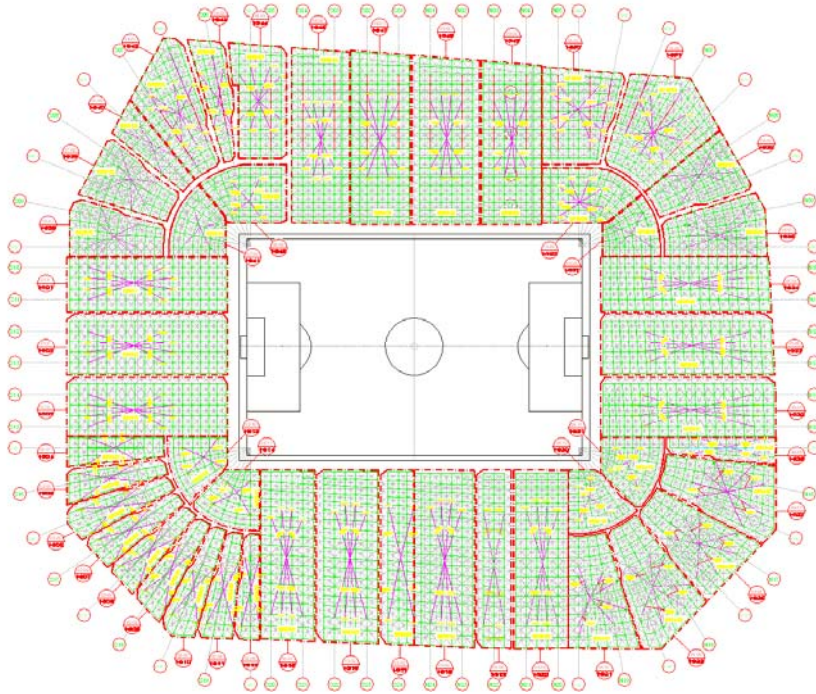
Схема разбивки металлических конструкций покрытия на монтажные блоки
